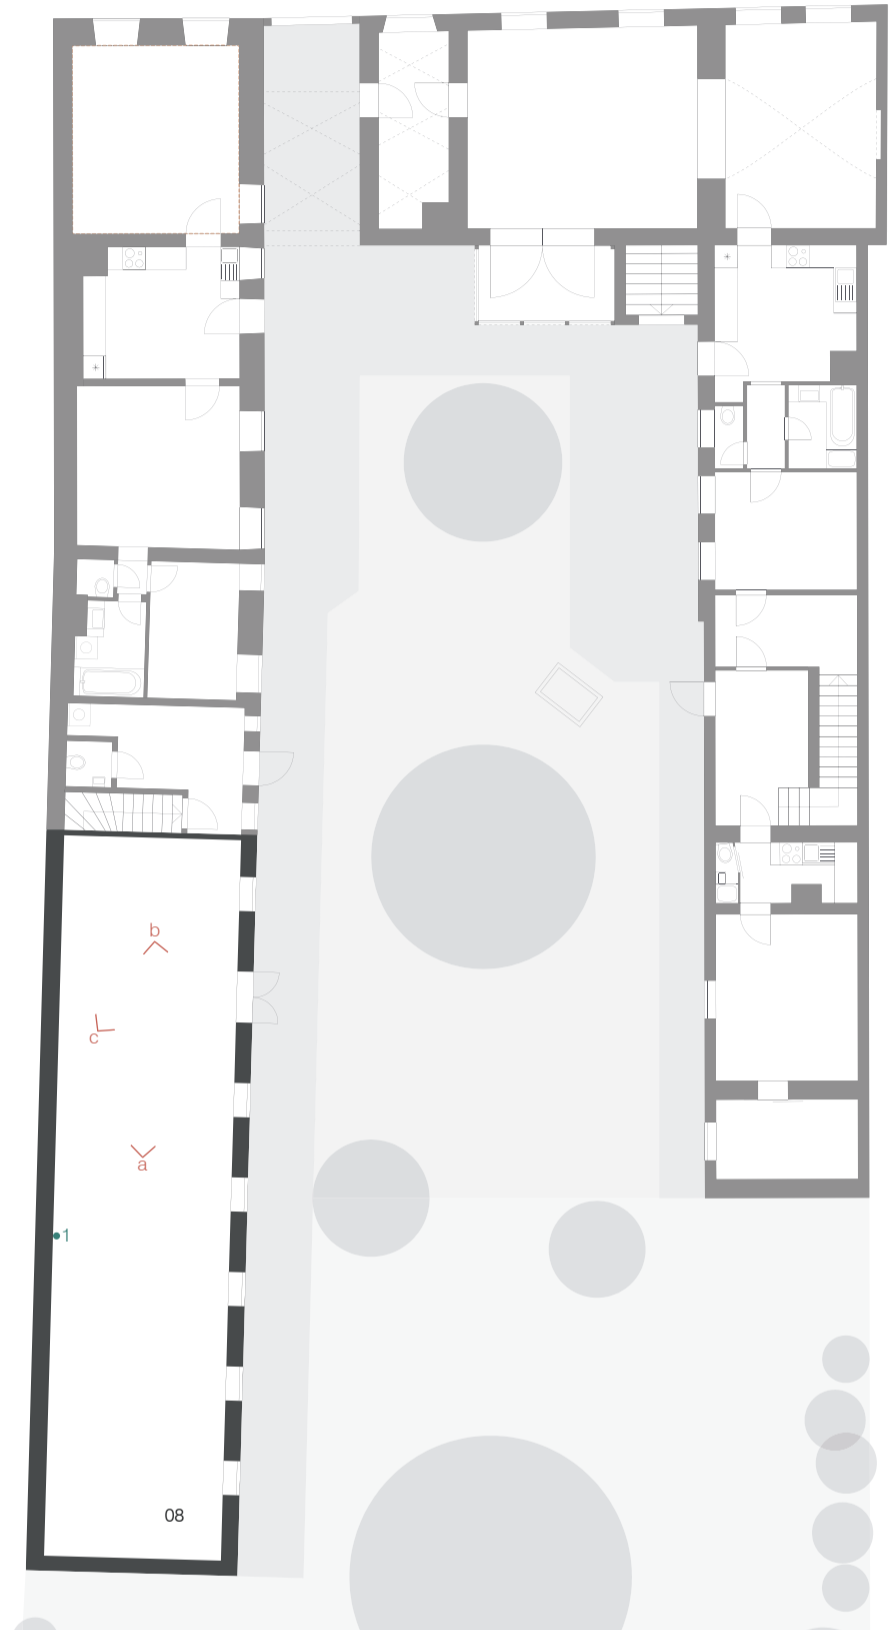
Grundriss Erdgeschoß | M 1:200 | Raum 08
